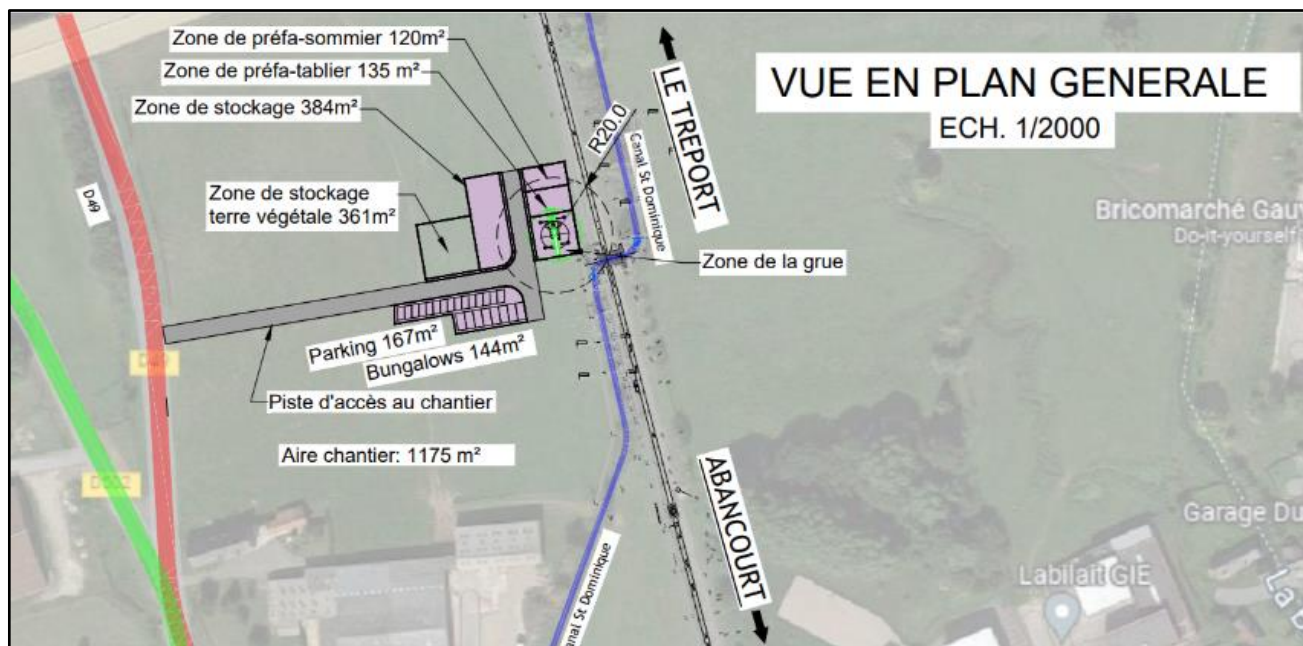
Plan général du chantier et de la base-vie – surface totale de 1175m<sup>2</sup>
